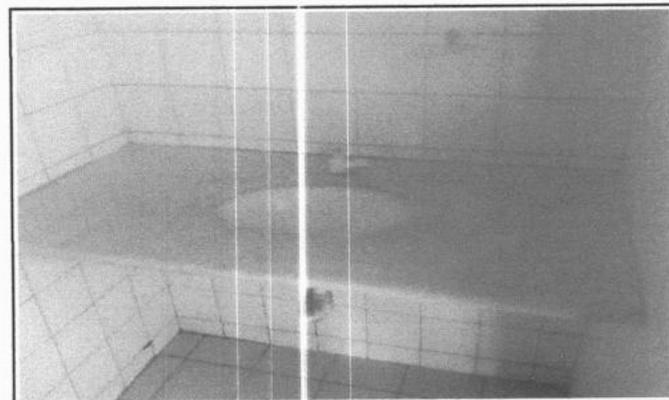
SUBSTITUIÇÃO DE TORNEIRAS DANIFICADAS
